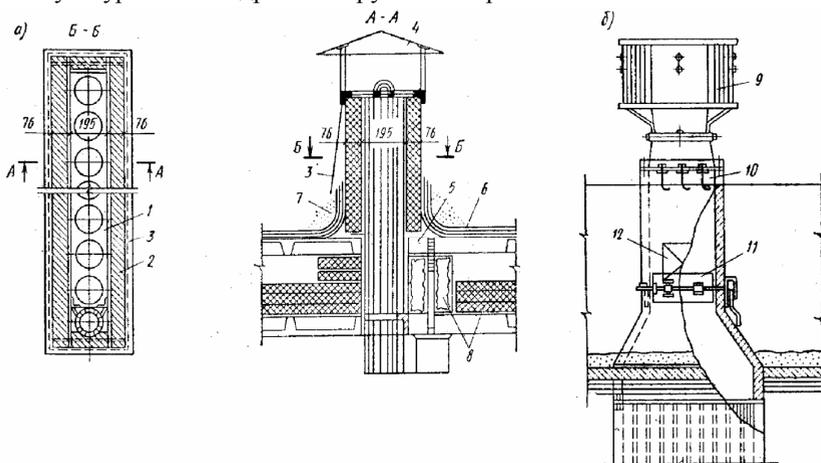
Вытяжные шахты: 1 – железобетонный блок; 2 – щиты из цементно-фибролитовых плит (внешние поверхности утеплителя покрыты битумом); 3 – фартук из оцинкованной кровельной стали; 4 – зонт металлический; 5 – борт из асфальта или цементного раствора марки 100; 6 – рулонный гидроизоляционный ковер из четырех слоев рубероида; 7 – присыпка гравием на битуме; 8 – панель в комплекте; 9 – дефлектор; 10 – болты для крепления дефлектора, заделанные в стенки шахты; 11 – дроссель-клапан; 12 – люк
